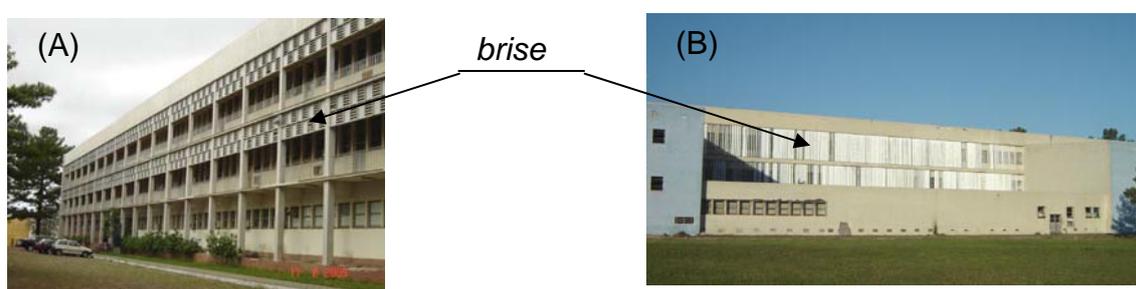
Vistas externas – (A) fachada Leste (B) fachada Oeste
